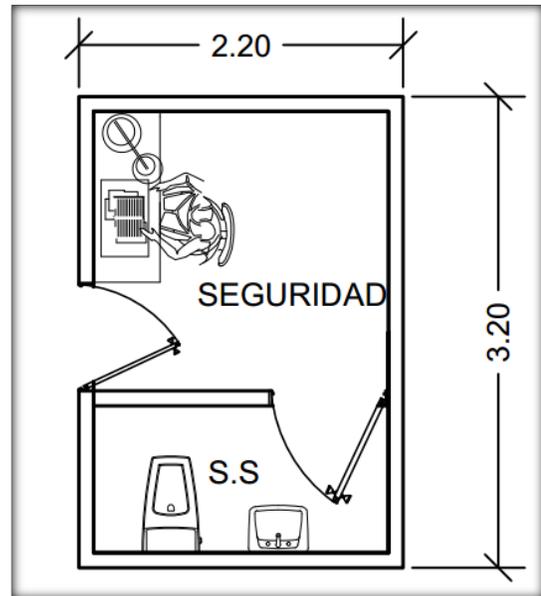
propuesta distribución en planta inspección sanitaria y seguridad SIN ESCALA
